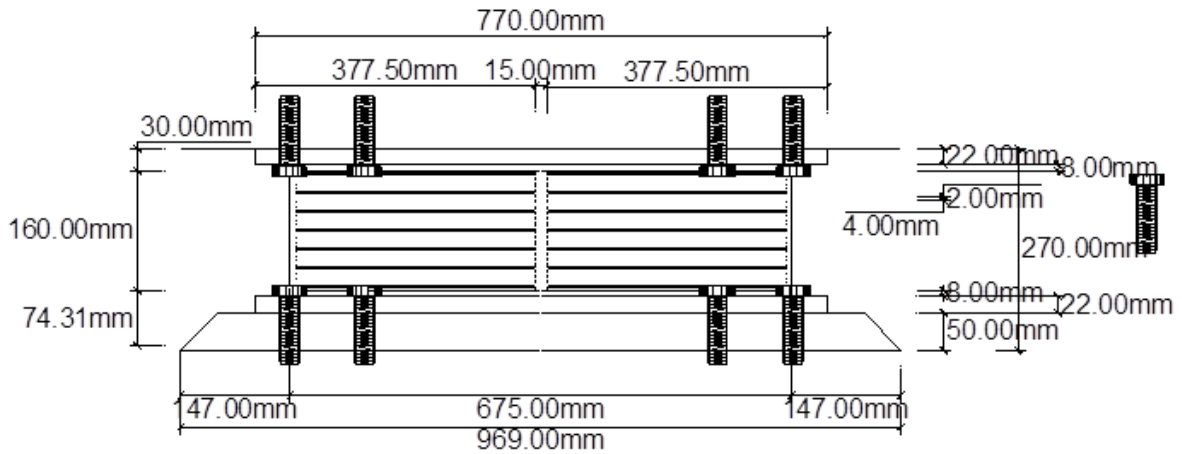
Dispositivo aislador HL075X4R – Vista en elevación
